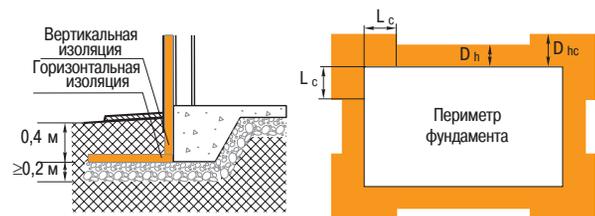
Поперечный разрез и план расположения изоляционных плит «Пеноплэкс®» для отапливаемых помещений при  $R_f=0$
